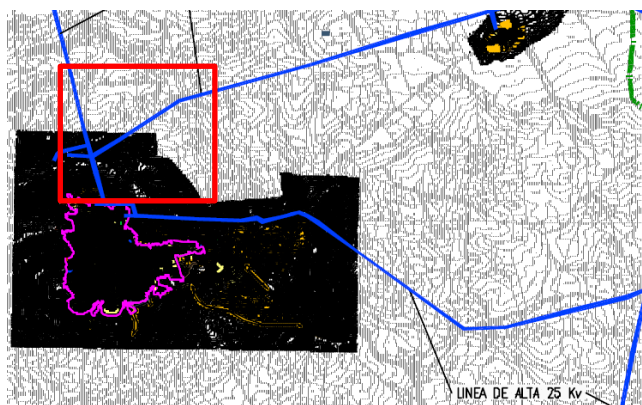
Tendido eléctrico de la zona según plano PGOU
